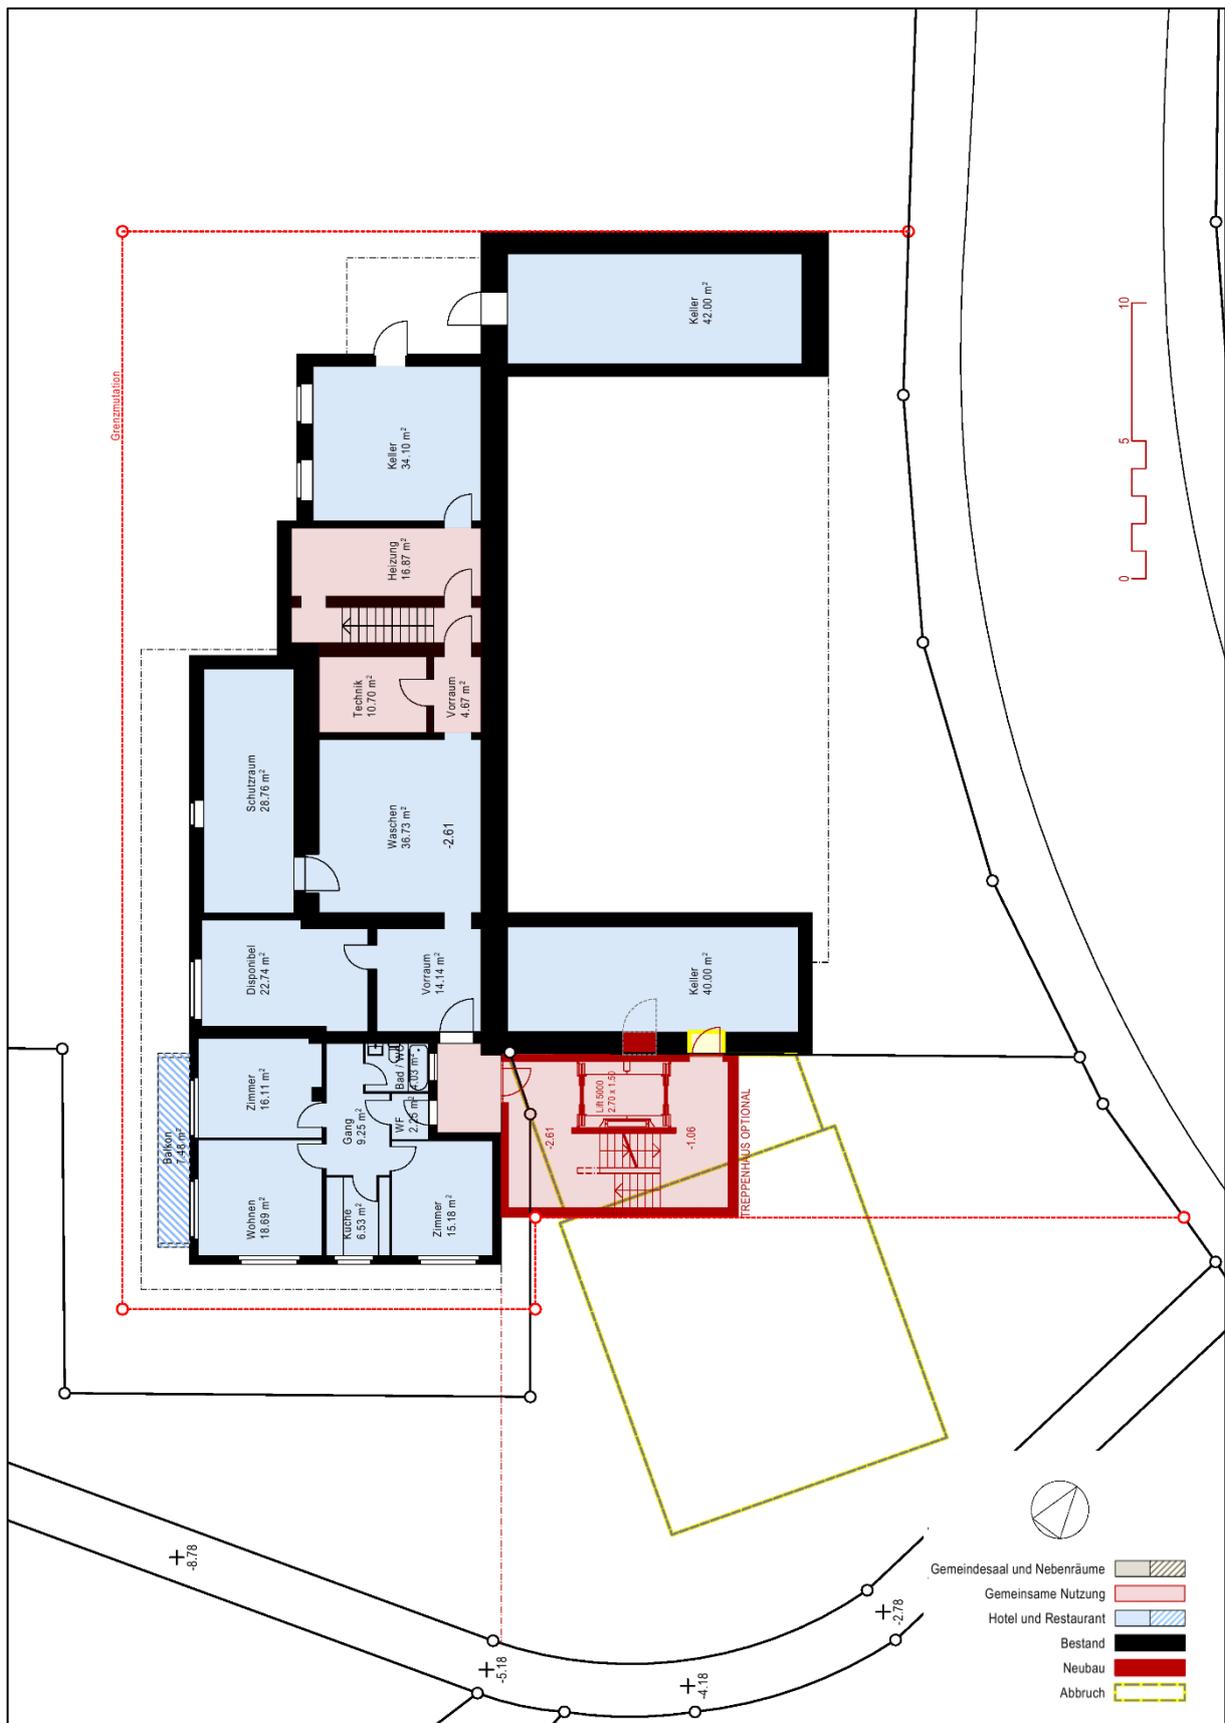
Grundriss 1. Untergeschoss, mit Distanzangabe, Stand: 3.11.2022
